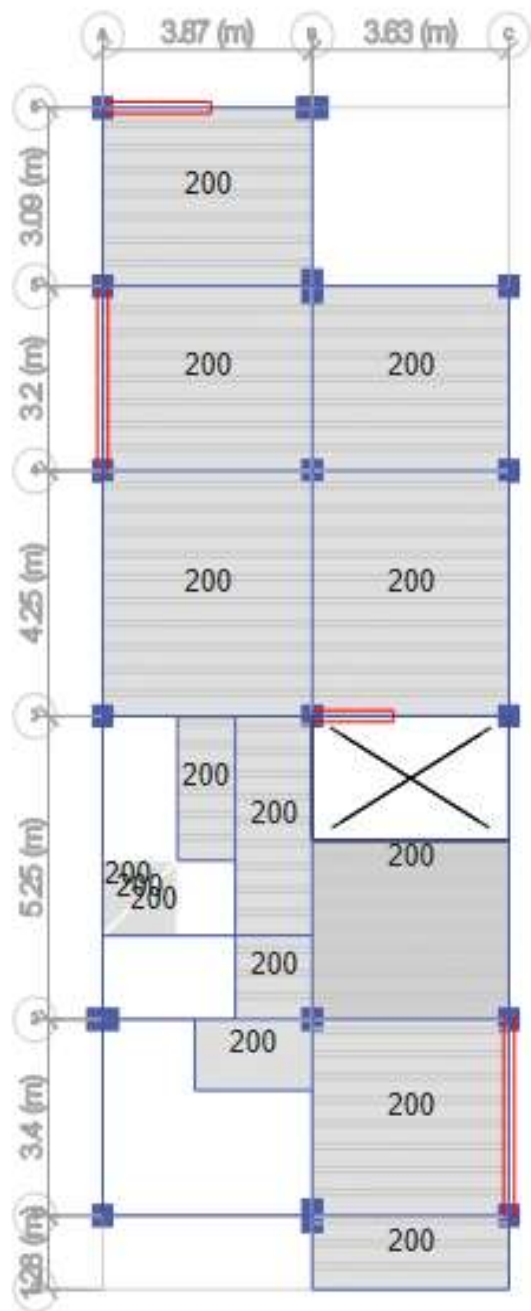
Vista de Planta Carga vivas Asignada del 1er al 3er piso incluyendo escalera interior
